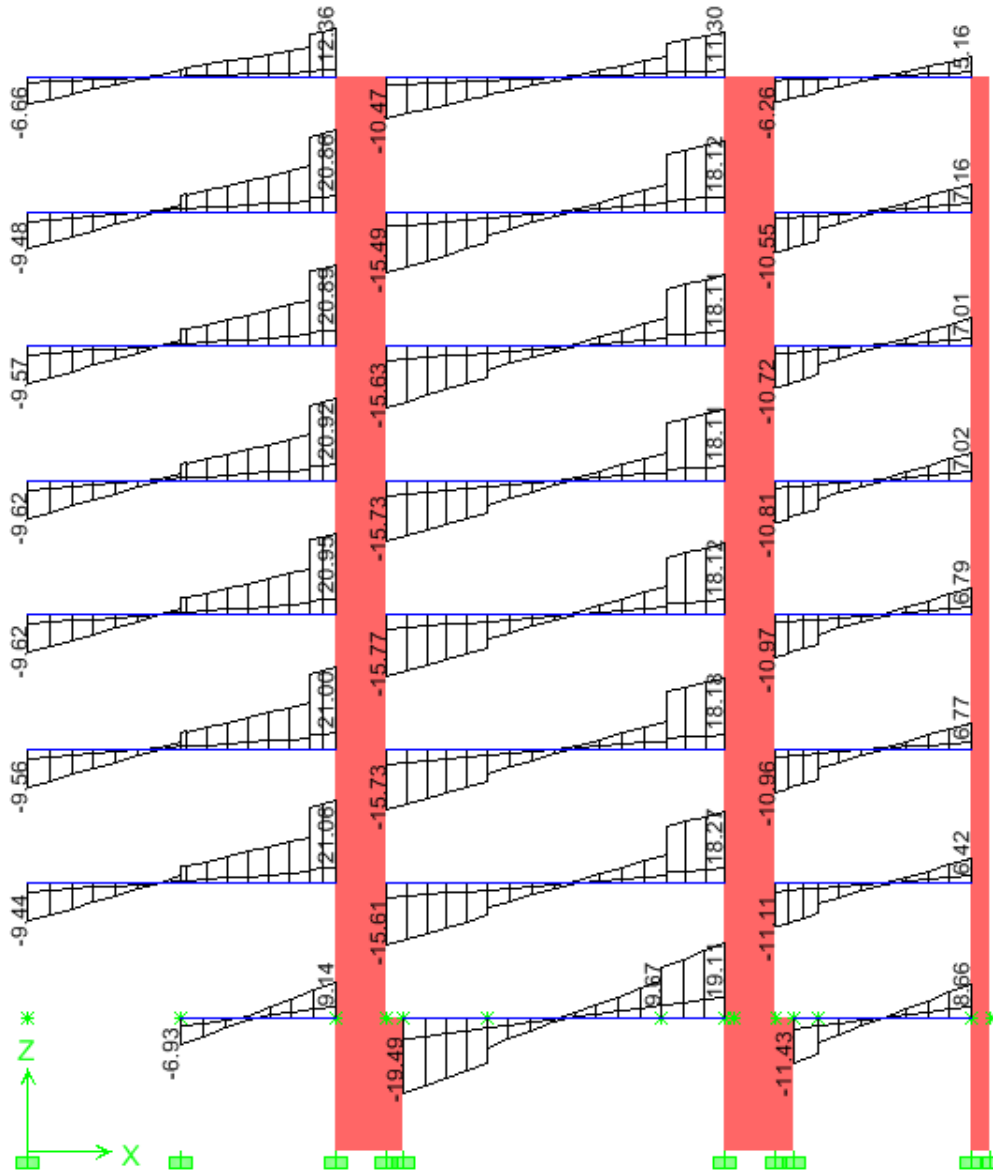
DFC en vigas de pórtico de eje 2-2 para 1.4CM + 1.7CV
